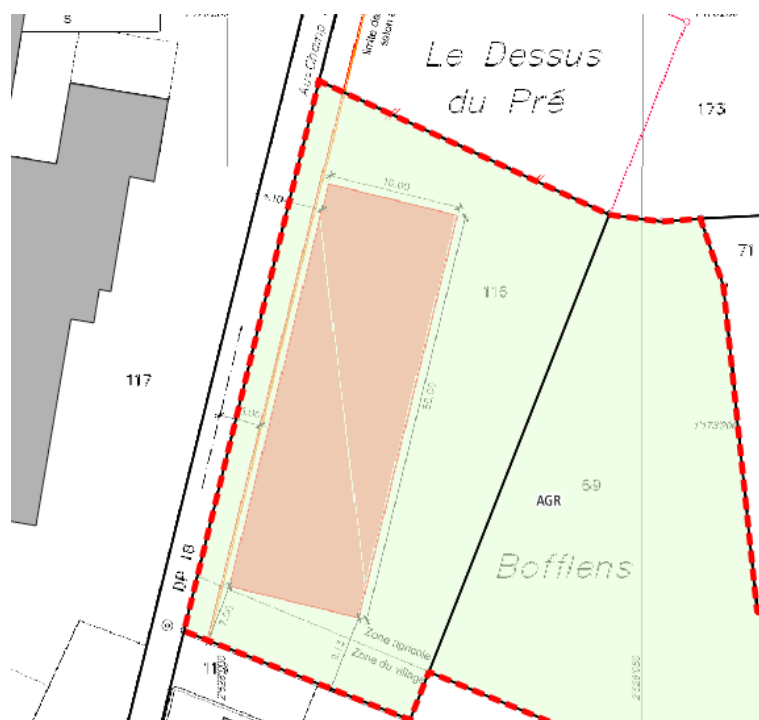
Extrait du plan d'affectation soumis avec le plan du bâtiment projeté sur la parcelle 116
